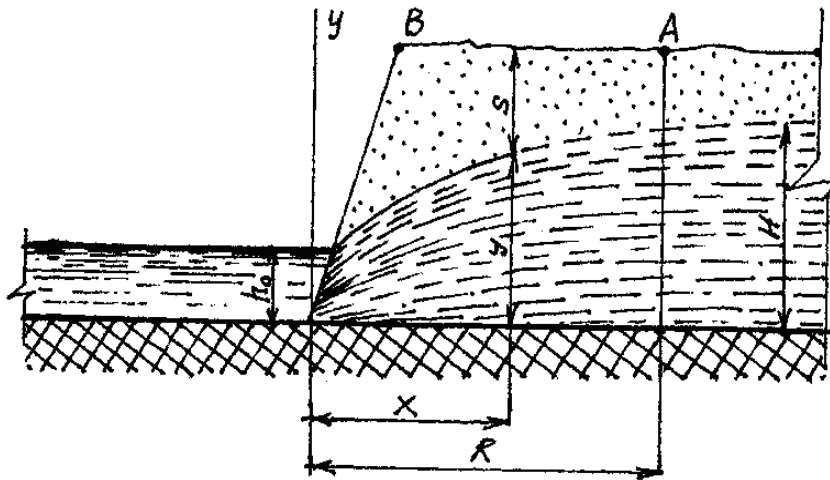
Схема для визначення припливу води до будівельного котлована
